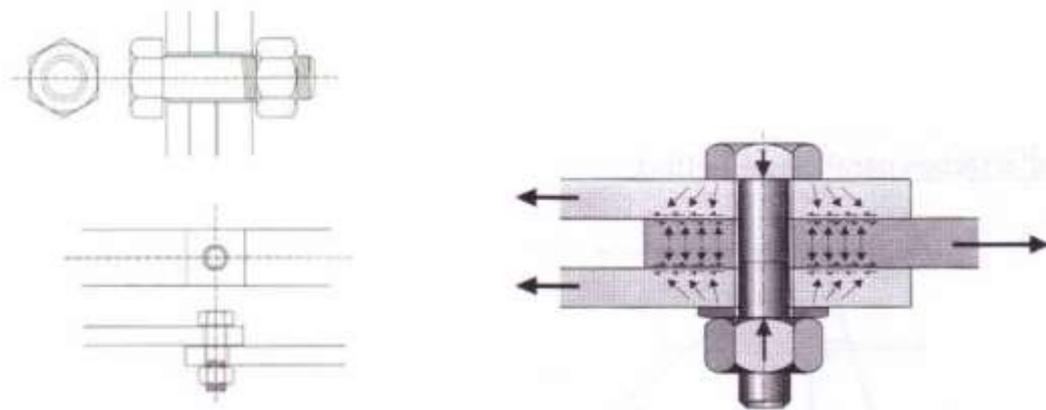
ASSEMBLAGES PAR BOULONS HR
